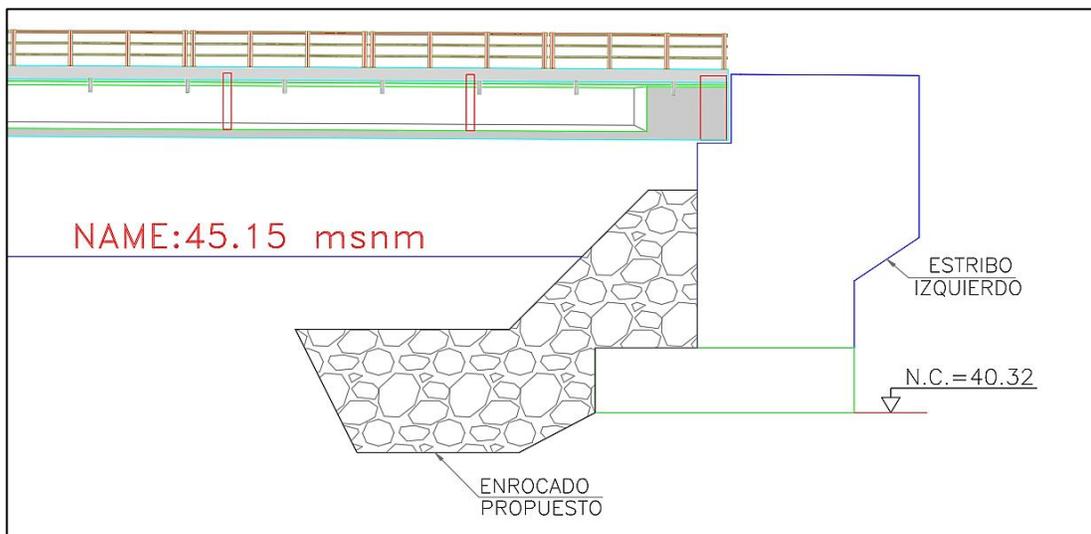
Vista en elevación del enrocado en el estribo izquierdo.
